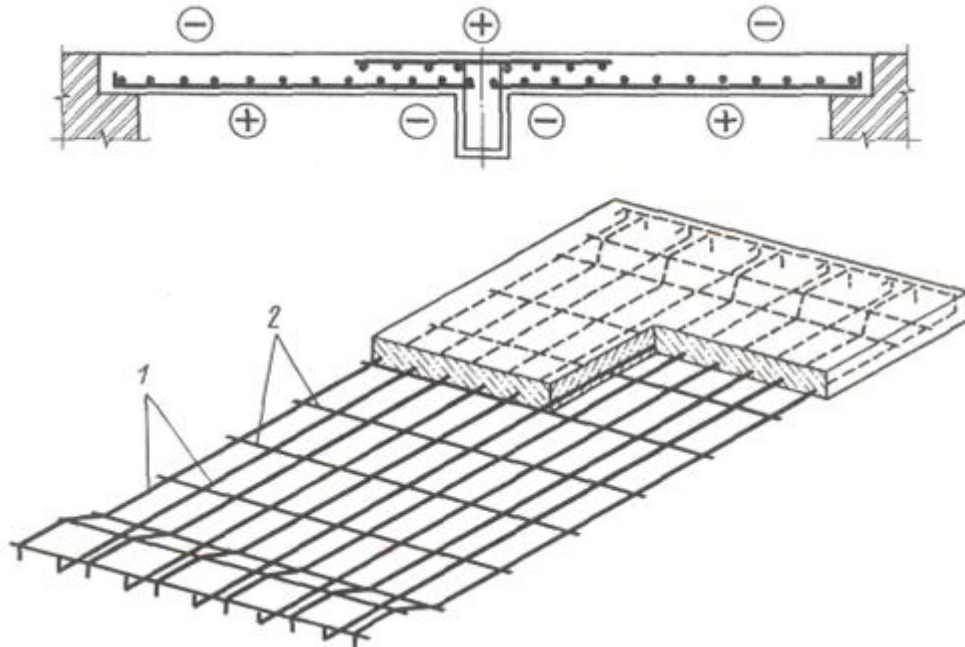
Армуння плити: 1 – робоча арматура; 2 – конструктивна арматура
